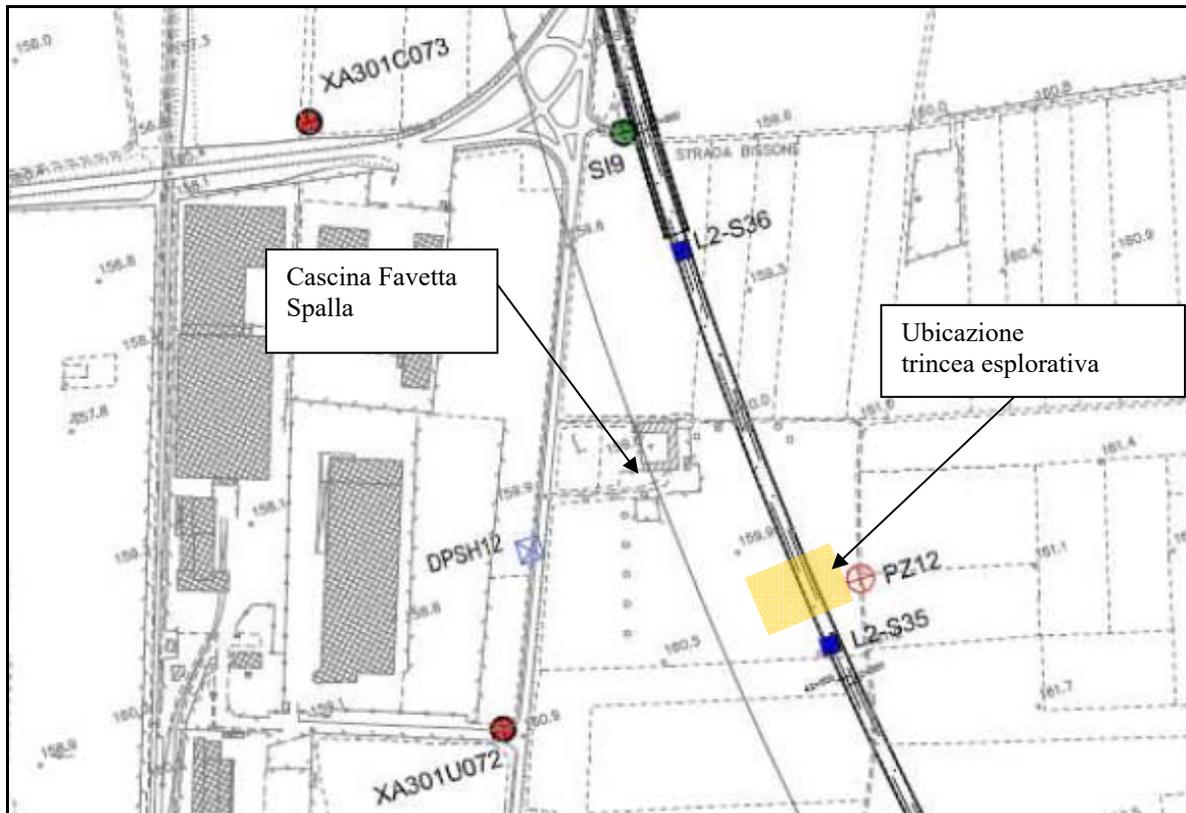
Ubicazione Cascina Favetta Spalla, km 42+200
